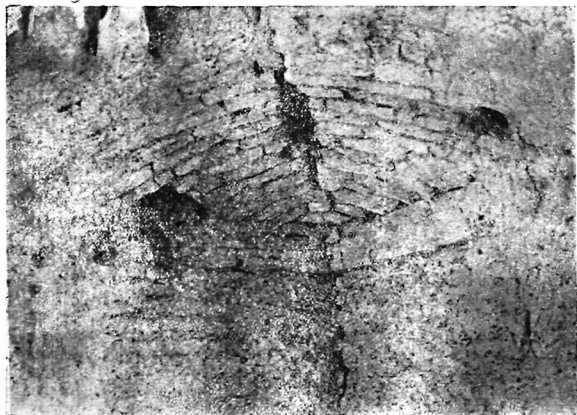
Сырцовый свод бахчи (дом в квартале средневековых керамистов Мерва) — ревязь кладки. Выведение свода бескружальное (в отличие от европейских сомкнутых сводов, которые выводятся с помощью кружал), местонахождение точек кривизны определяется натяжением по диагонали бечевки, закрепленных в противоположном углу.
